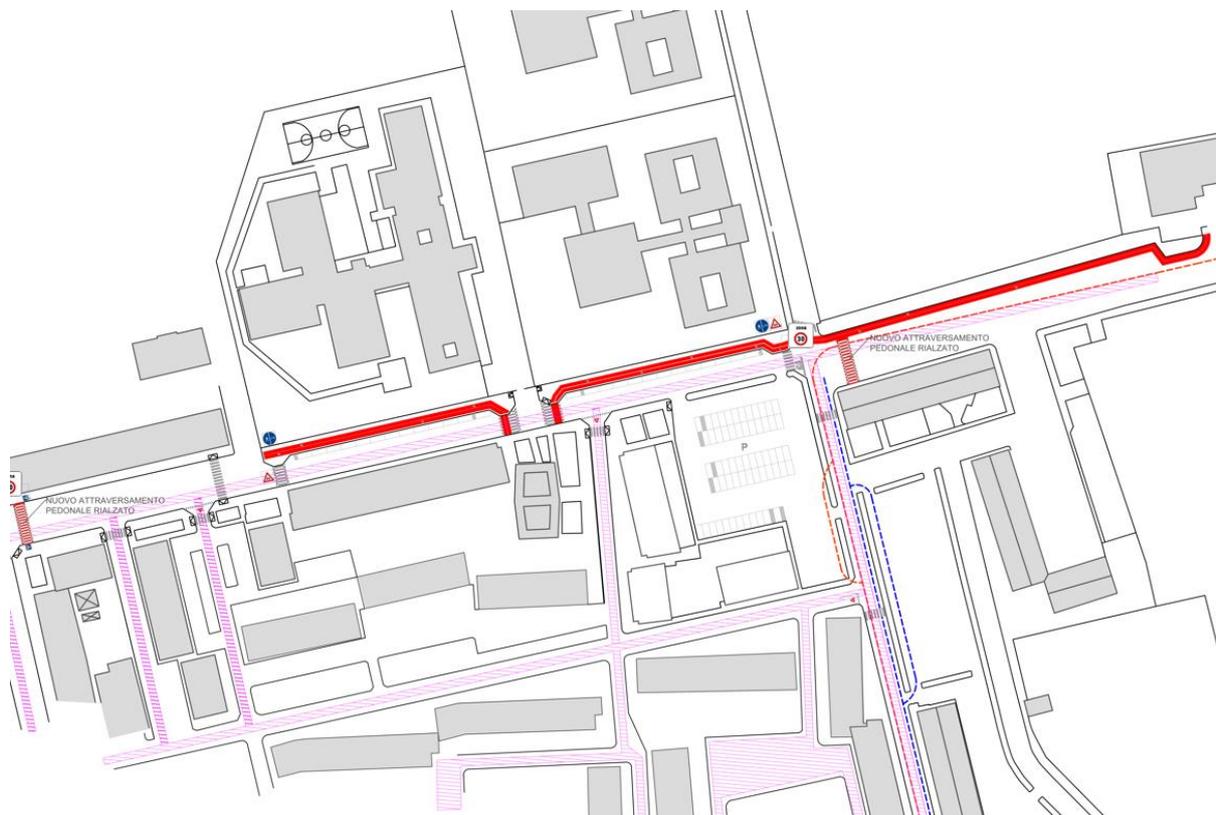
Planimetria di progetto in via Deledda - estratto di tavola
